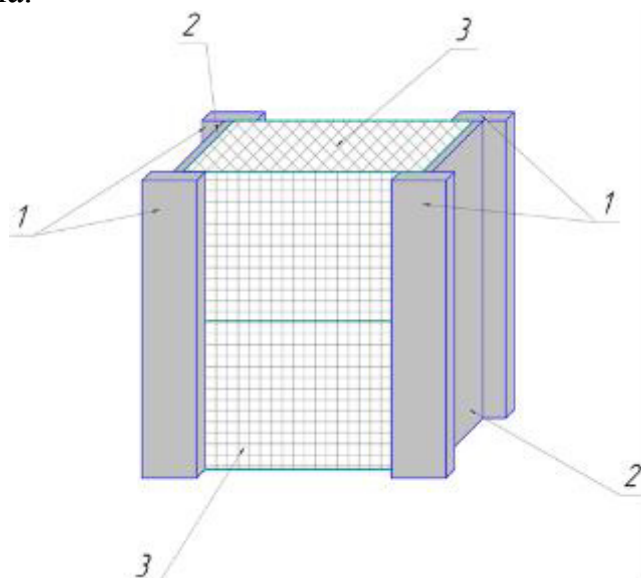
Элемент стены каркасного дома с армированными стеновыми блоками из пресованного камыша: 1 – вертикальные балки; 2 – поперечные доски
